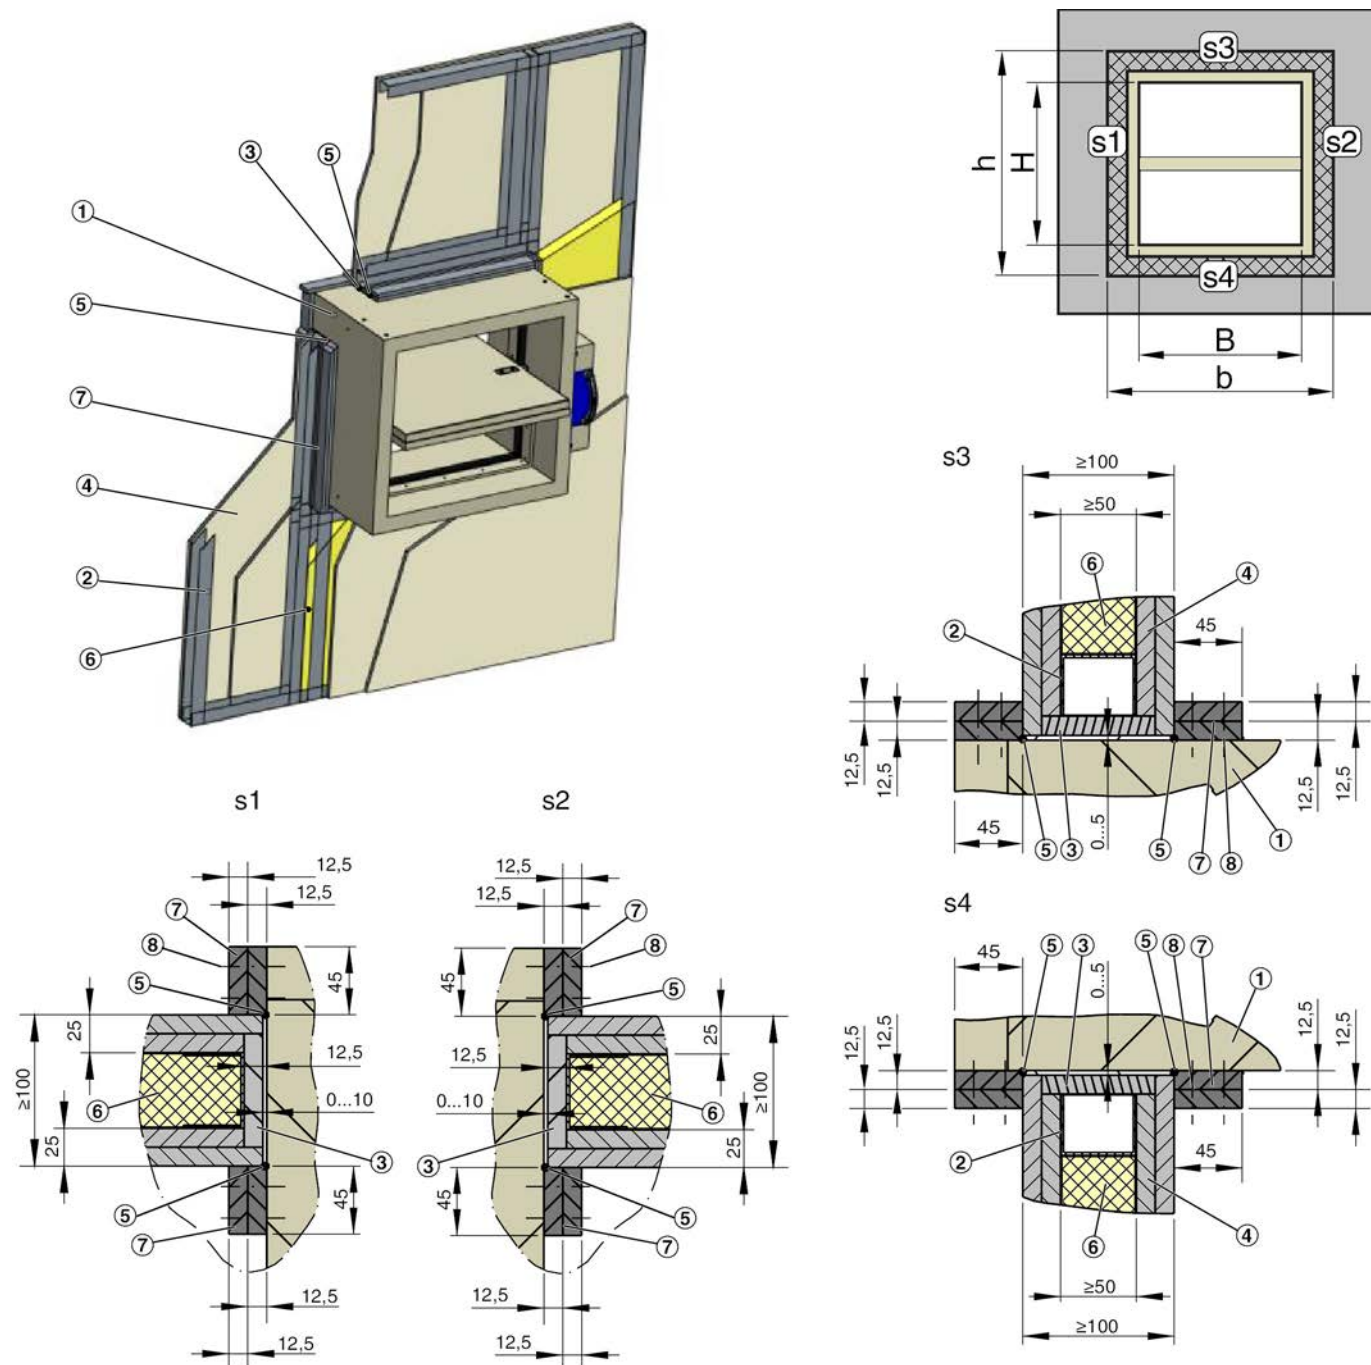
Installazione senza muratura in parete divisoria leggera, variante di installazione b, indice di classificazione:  $V_{ew}$
